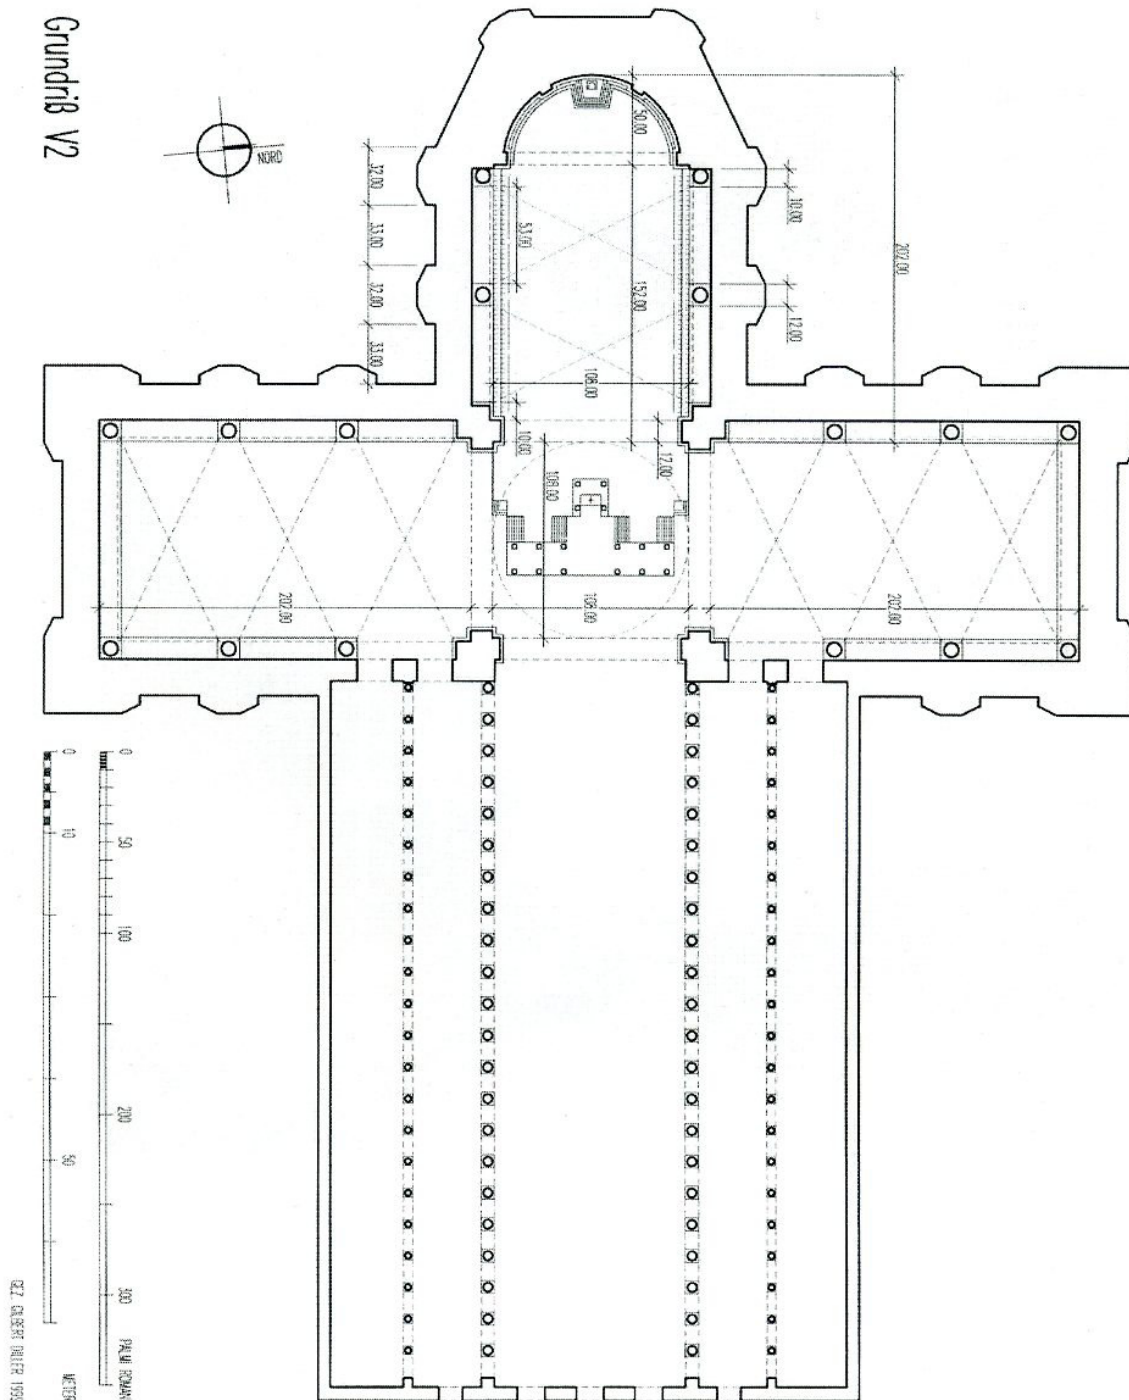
Grundrissrekonstruktion des Rossellinoprojektes, Version 2.
